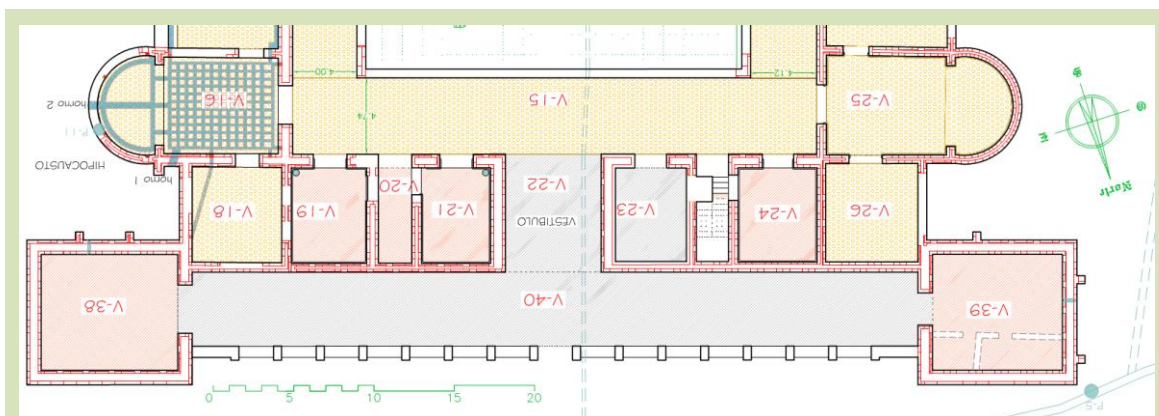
Ala norte, planta baja de La Olmeda. CGS.
